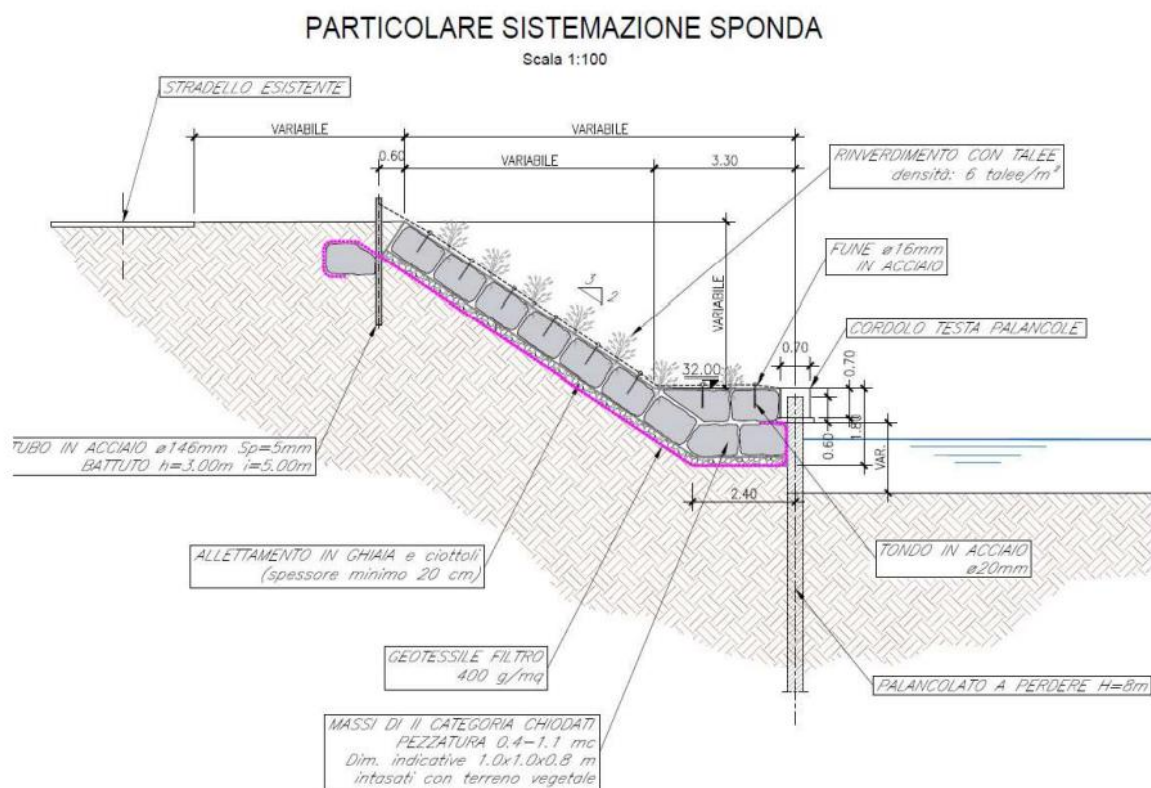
Sezione della sistemazione di progetto sulla sponda sinistra
